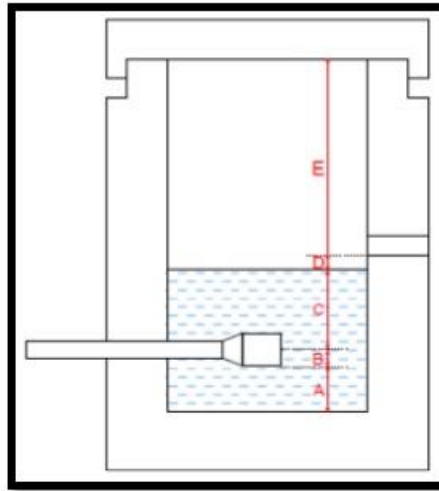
Cálculo de la cámara húmeda. Fuente: Ministerio de vivienda, construcción y saneamiento. (2018)
